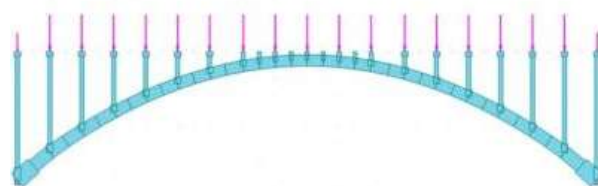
Modelo correspondiente a la Fase 1 de construcción: Arco aislado y montantes que soportan su peso propio y el tablero en fase de hormigonado
